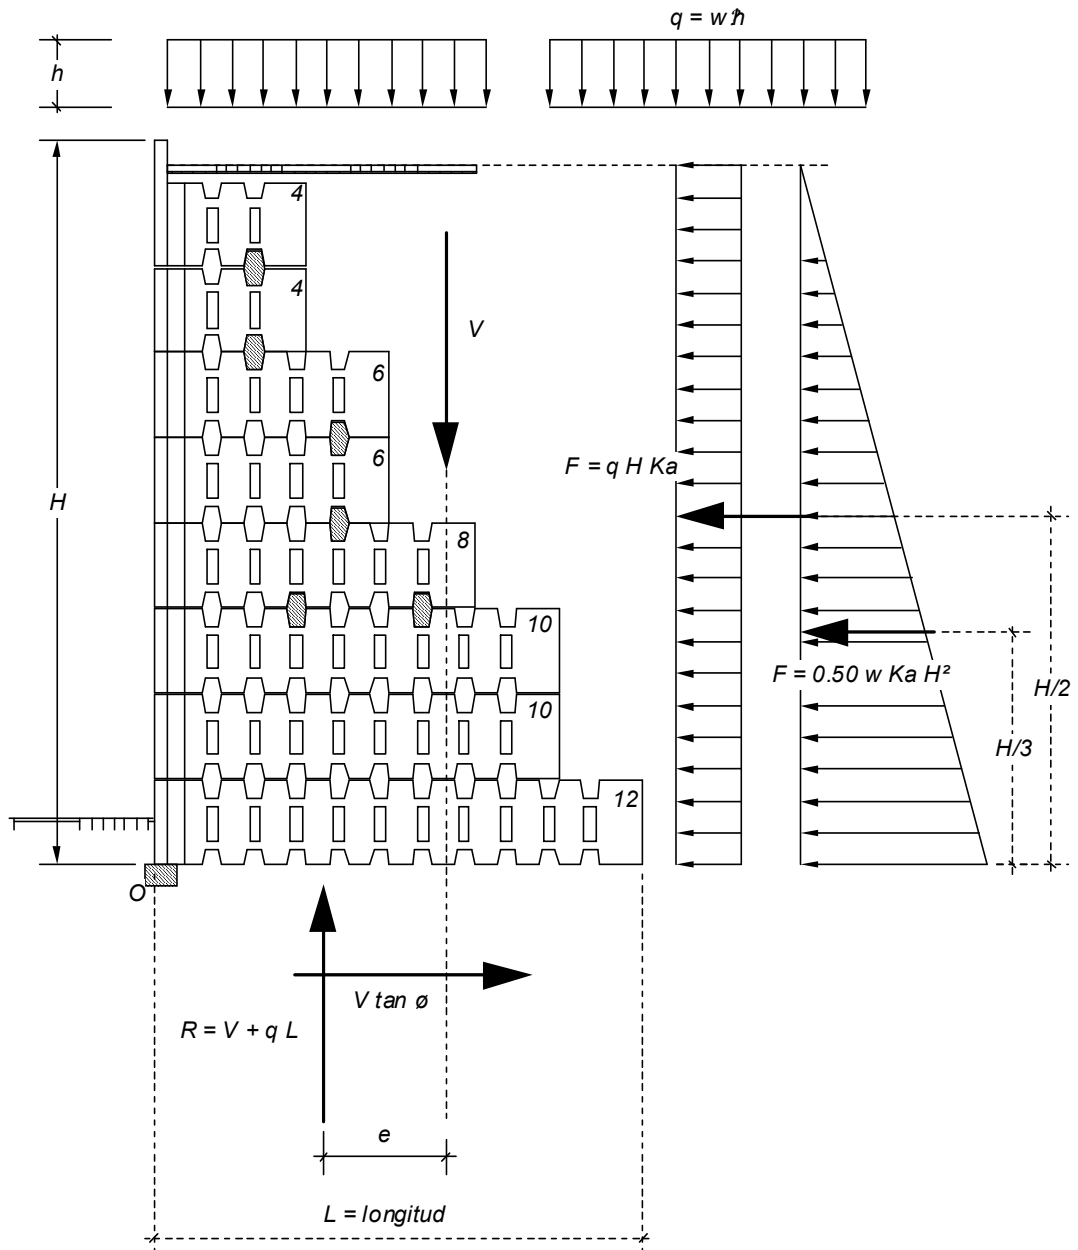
Fuerzas laterales y sobrecargas que actúan en un muro típico t-wall
